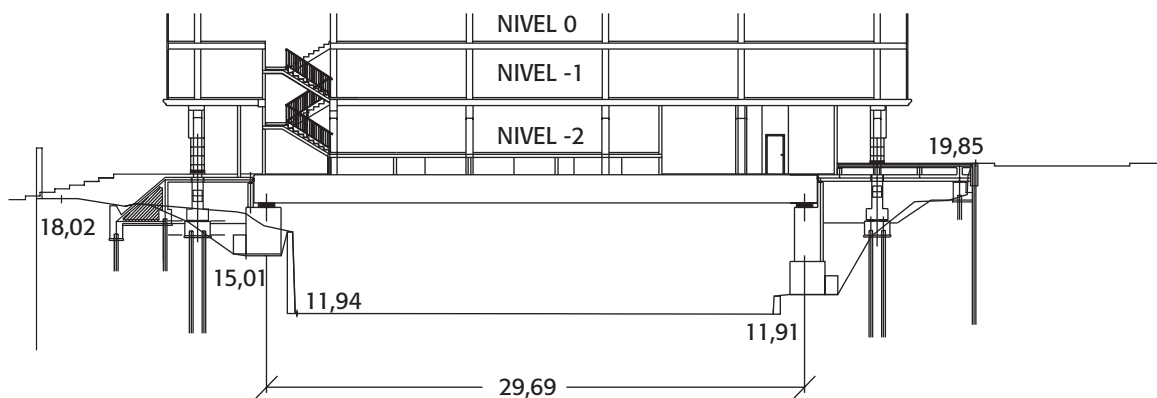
Sección por la viga 21, losa 1 al lado del Pont-Neuf (Av. Charles de Gaulle)
